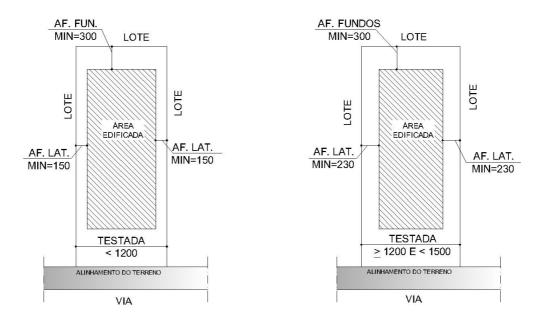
Afastamentos laterais e de fundos mínimos para lotes com testada inferior a 15,00m
